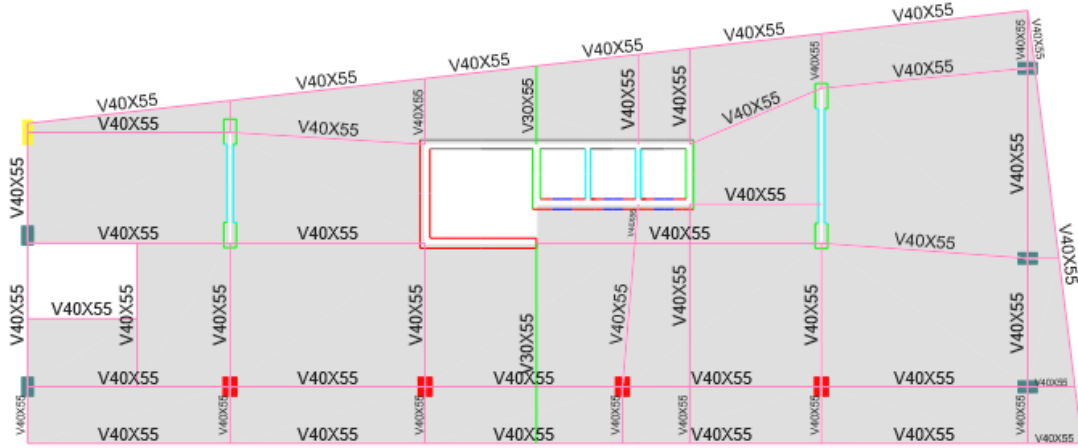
Planta Tipo N+44.08 a N+57.04
